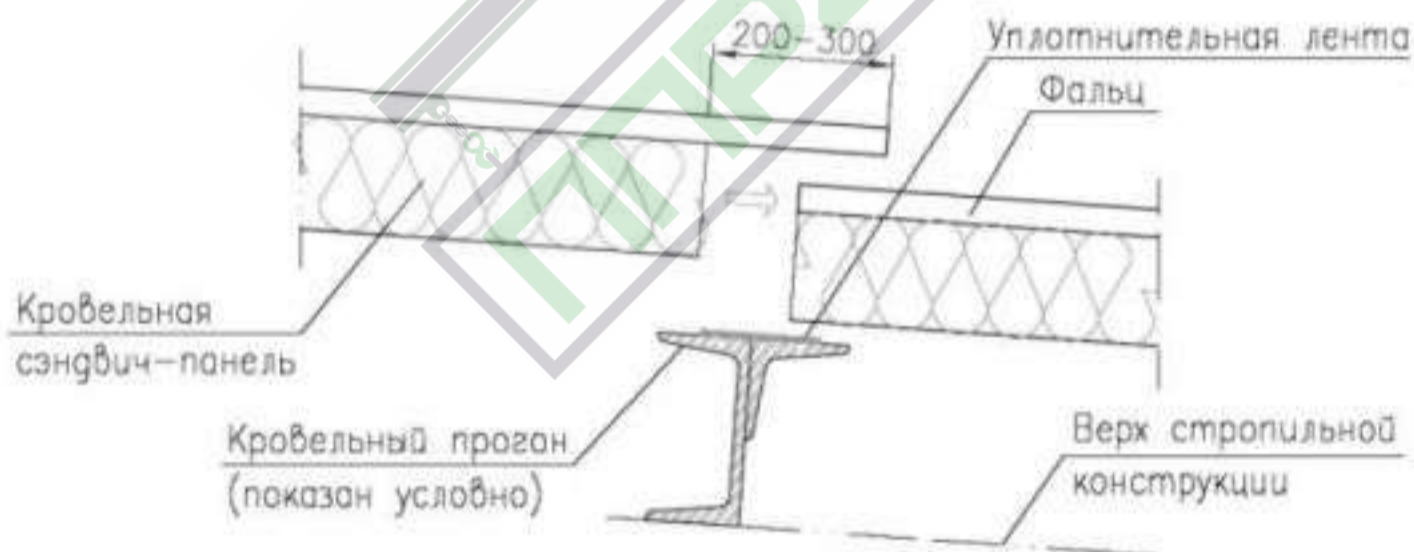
Монтаж кровельных панелей внахлест (окончание монтажа)
